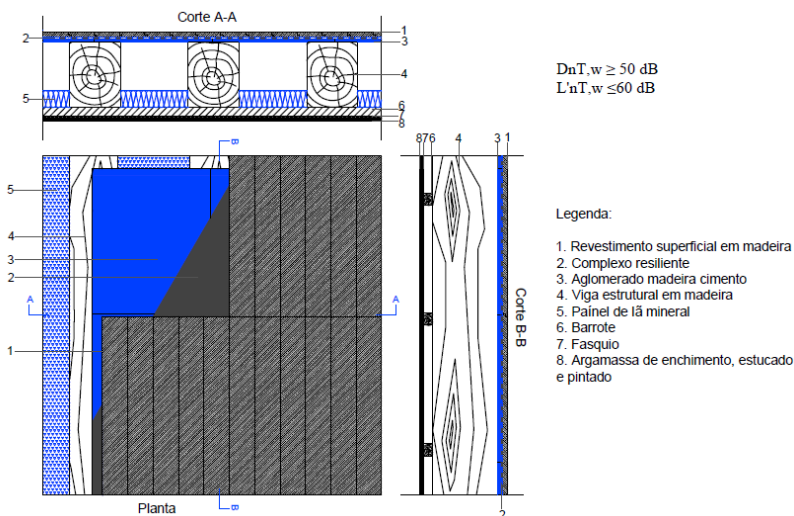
Esquema de pavimento tradicional reforçado com material resiliente e material absorvente sonoro
